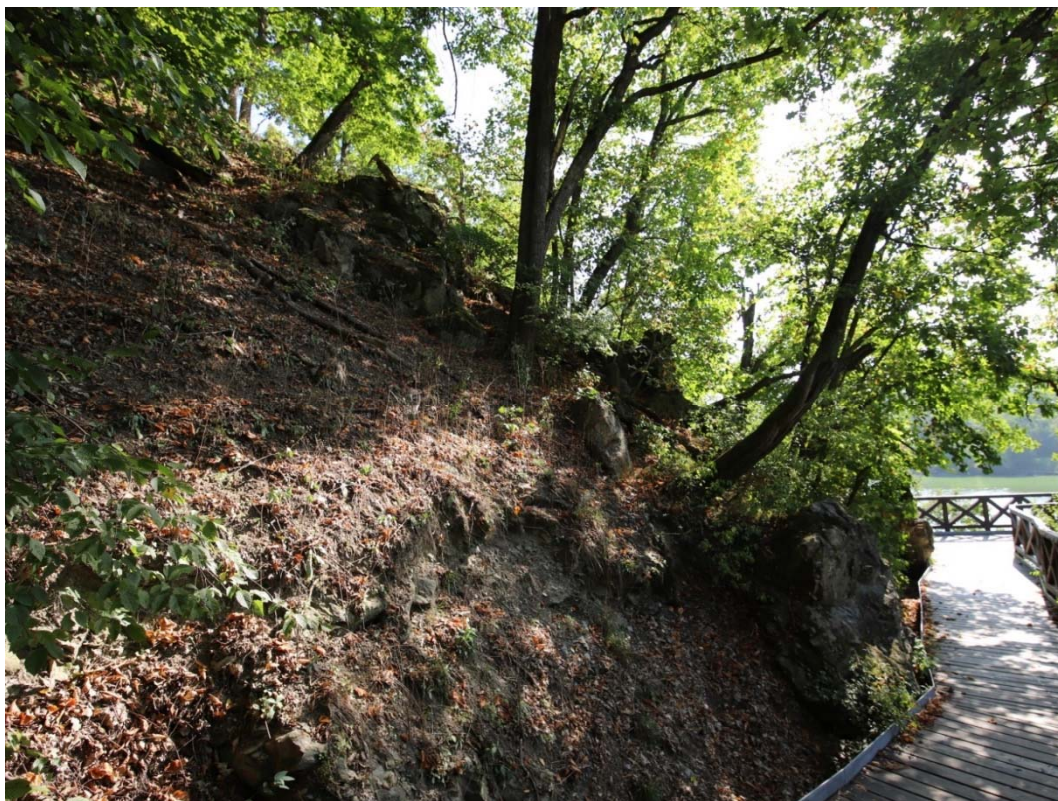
detail nasedání bloku na konstrukci stezky a detail rozevřené pukliny bloku, více jak 22 mm
